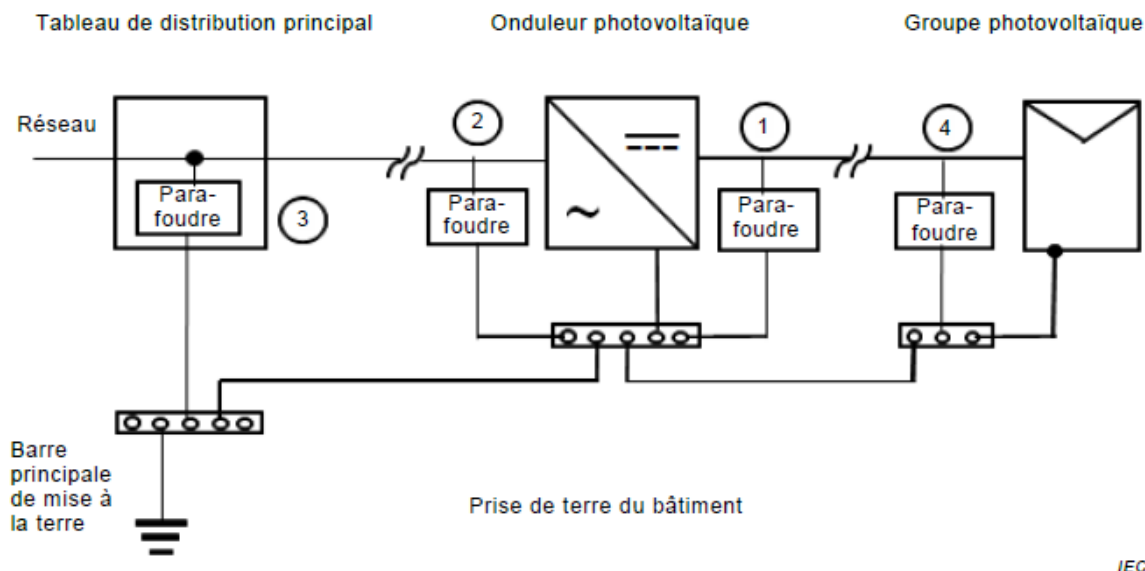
Installation des parafoudres dans le cas d'un bâtiment sans installation extérieure du système de protection contre la foudre
